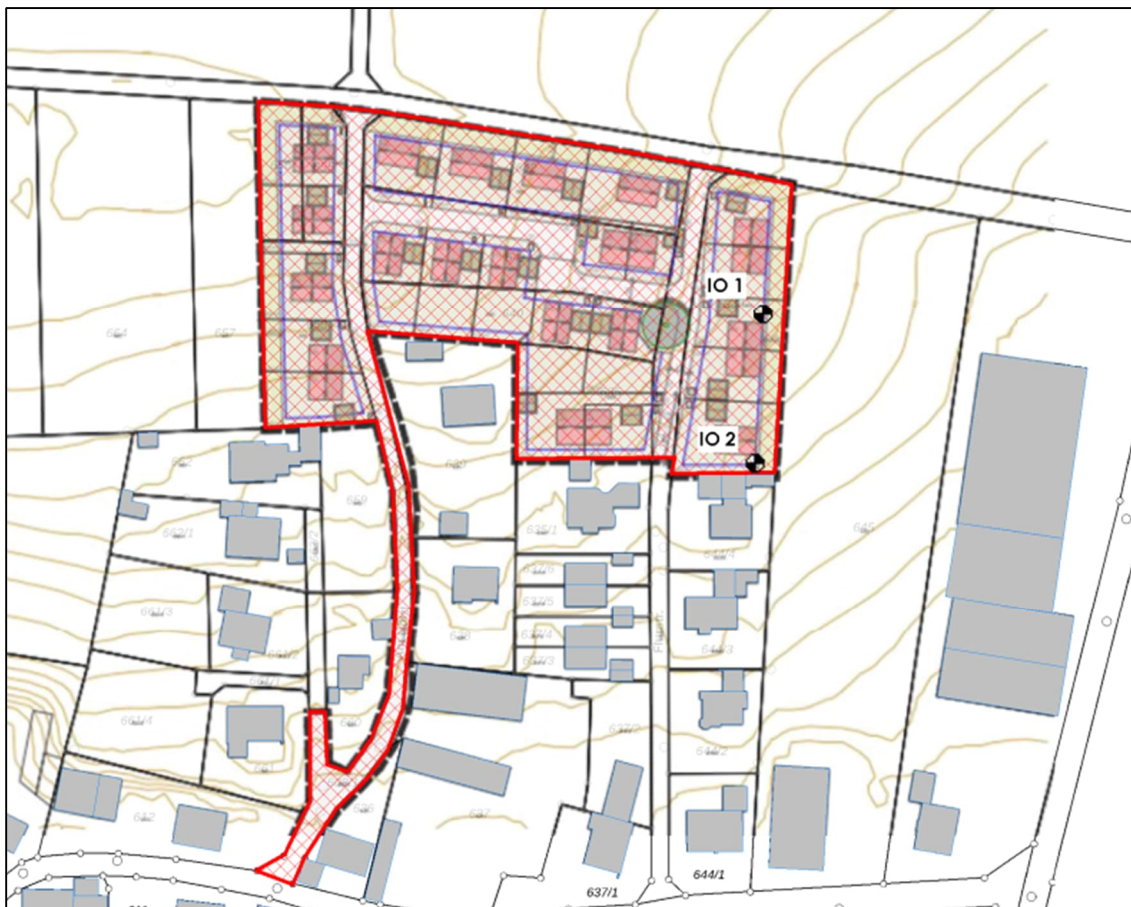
Lageplan mit Darstellung der exemplarischen Immissionsorte im Geltungsbereich des Bebauungsplans "Autenzell Nord" /6/
